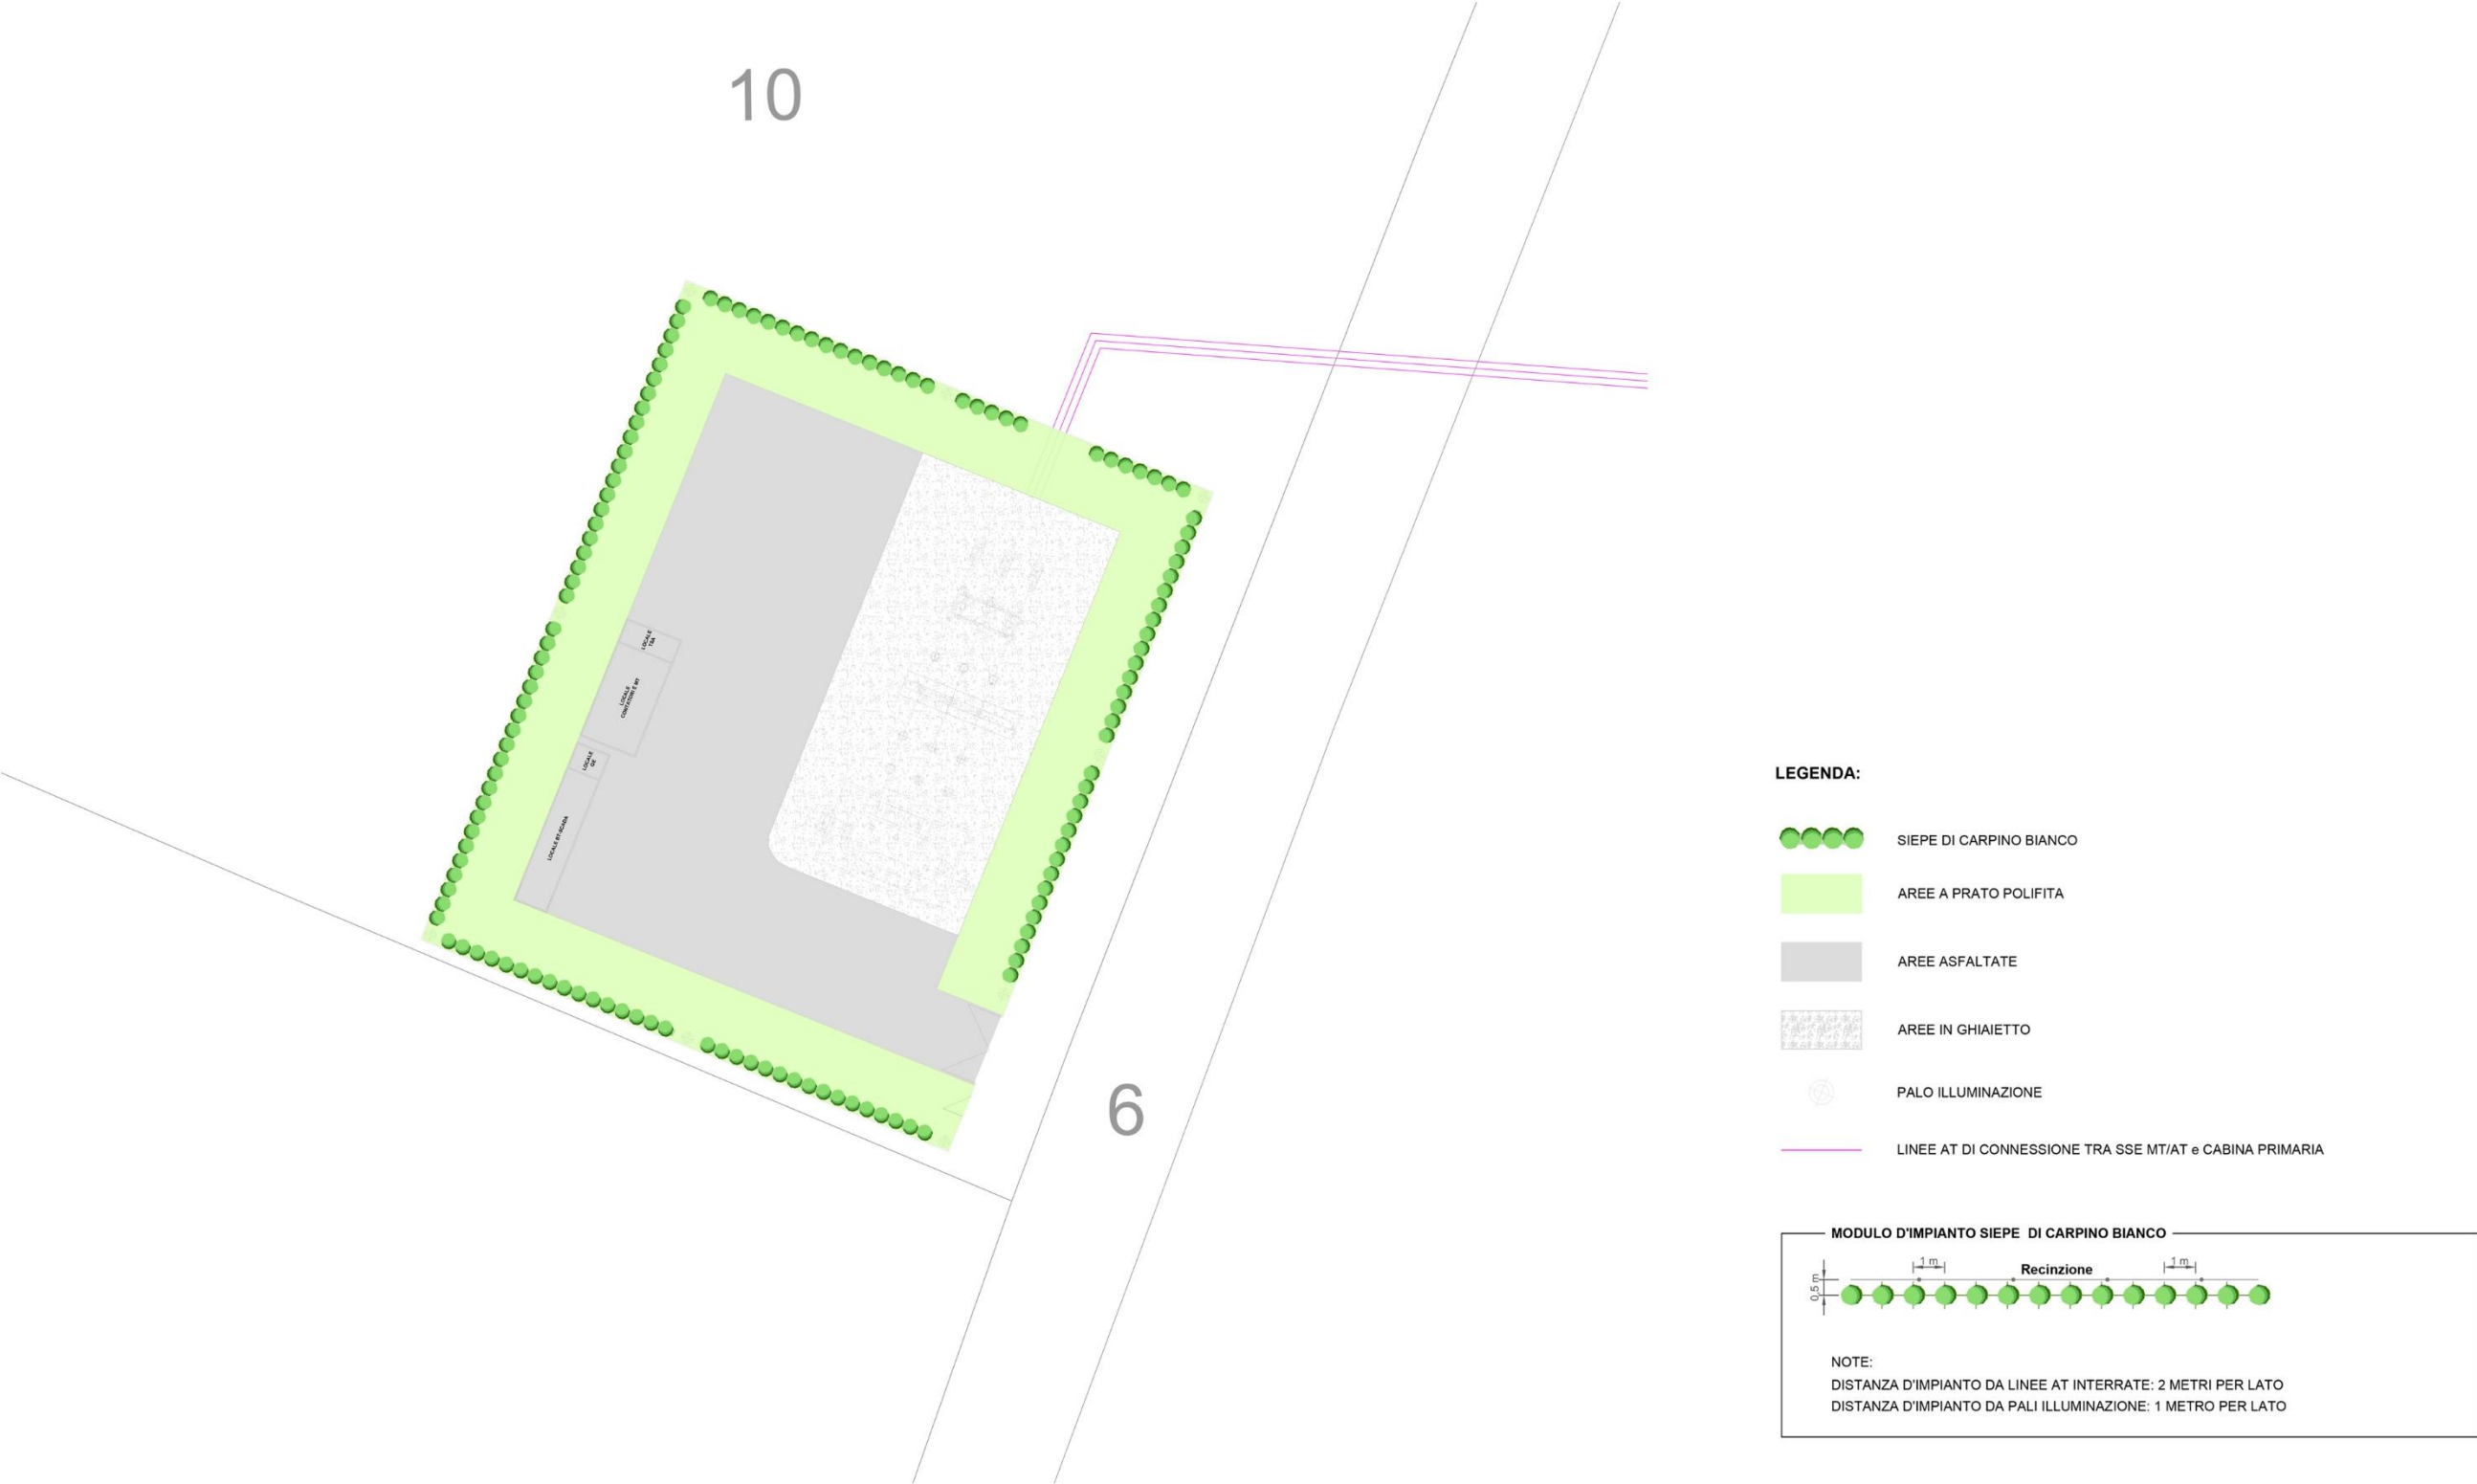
Stralcio della tavola di progetto Planimetria opere di inserimento paesaggistico-ambientale Sottostazione Elettrica, fuori scala.
